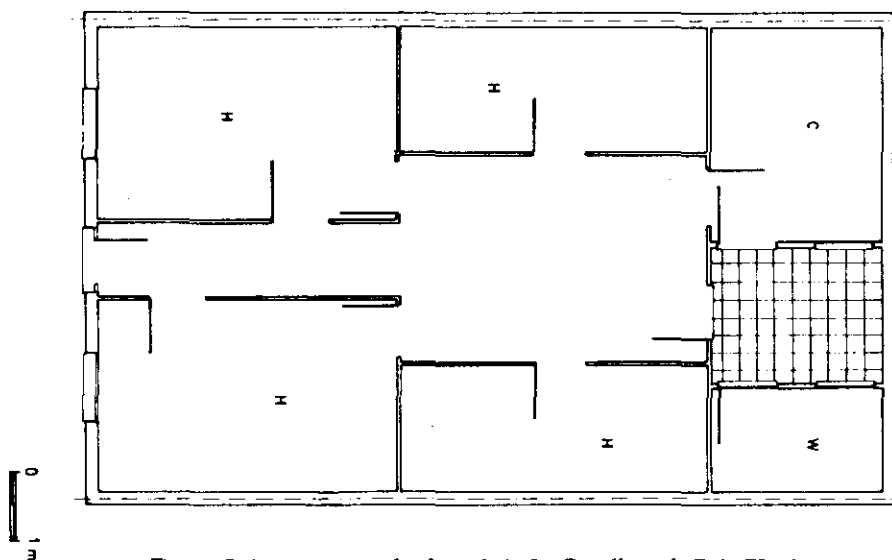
Apartamentos de planta baja. La Castellana de Dalt. 70 m²
